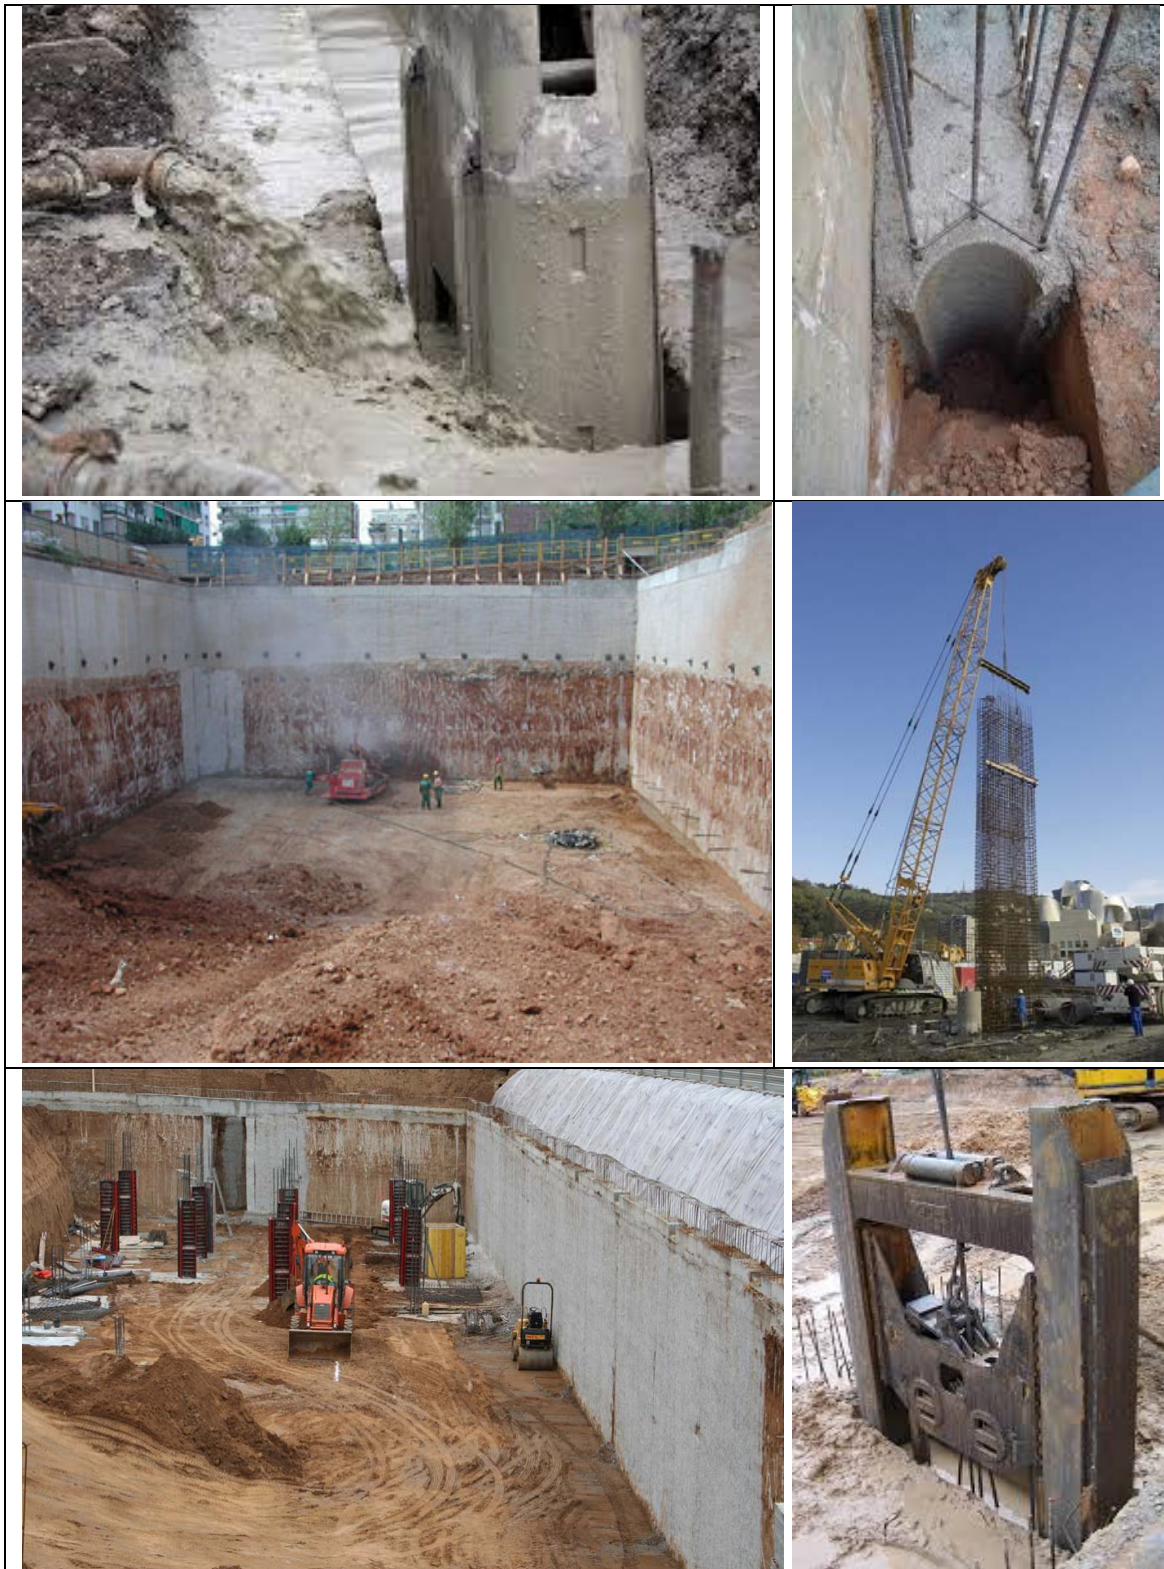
Ejecución de pantallas (Construmática 2008)
